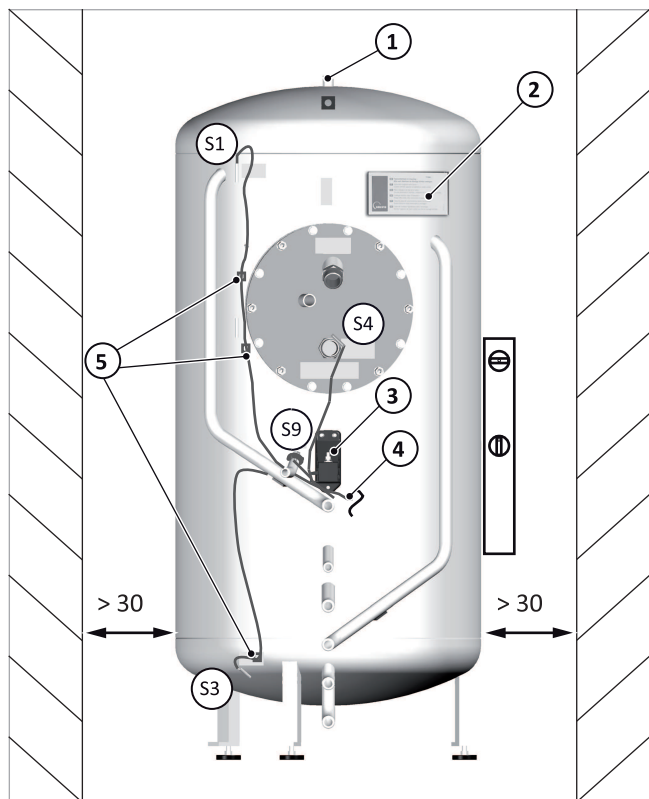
Posizione del sensore, tutte le dimensioni in cm
